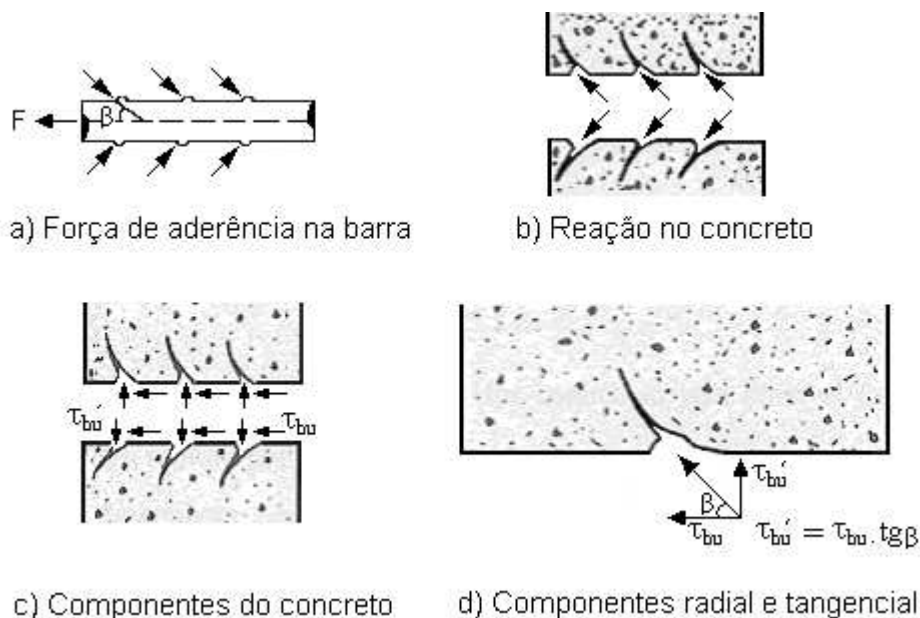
Forças atuantes entre a barra nervurada e o concreto.
